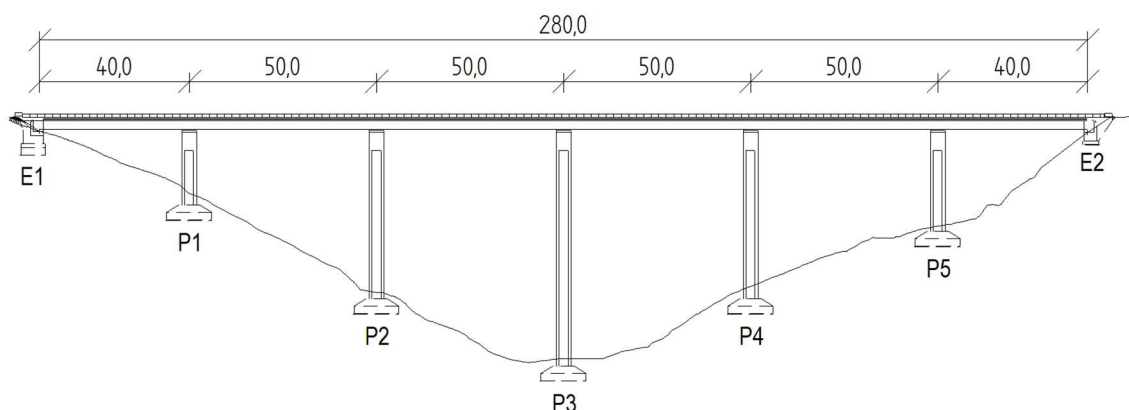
Perfil longitudinal da ponte considerada como caso de estudo.
